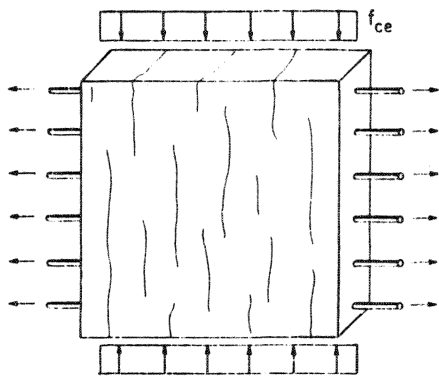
Betondruckfeld mit auf Zug beanspruchter Querbewehrung
